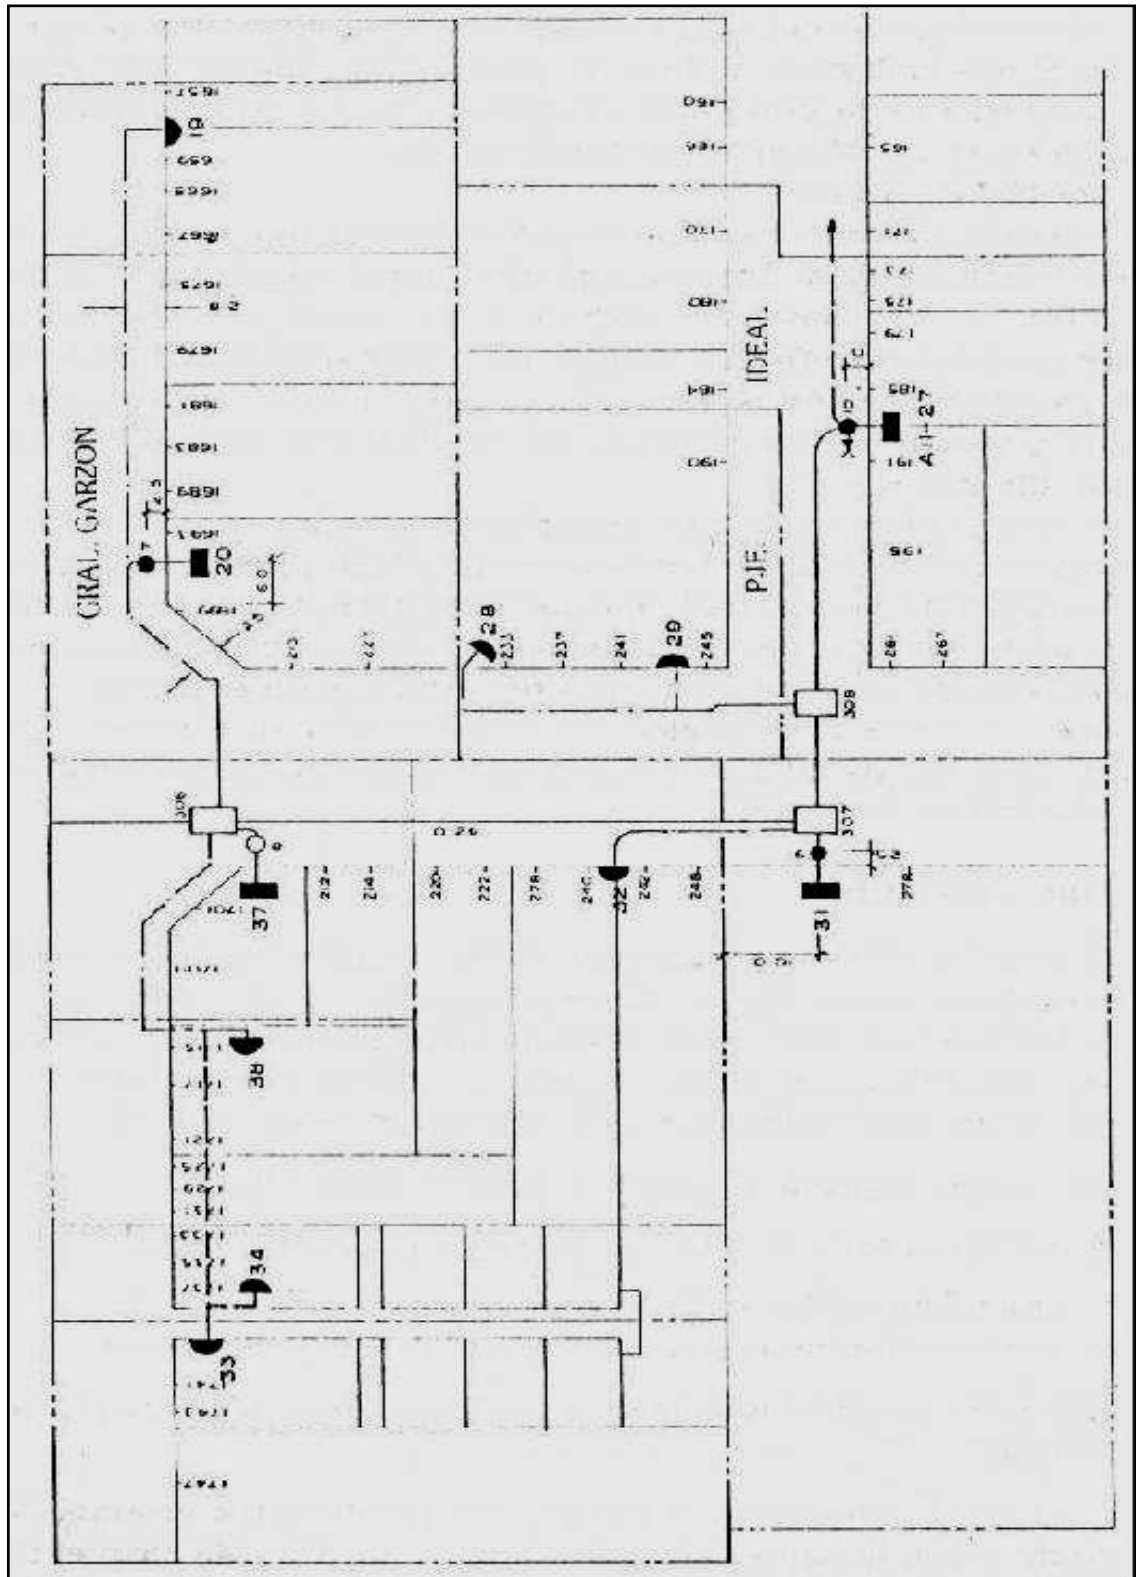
Plano catastral de manzana con distribución de cables y cajas terminales
